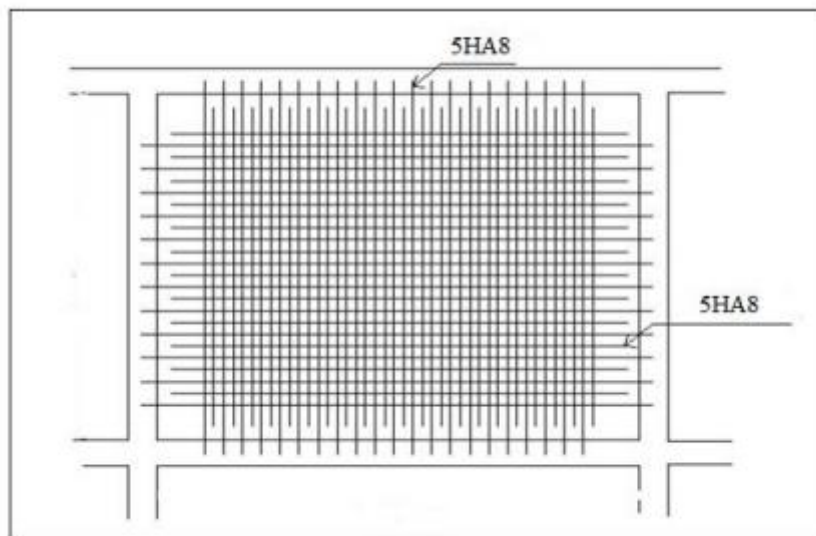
Ferrailage de dalle "cage d'escalier" en travée.
